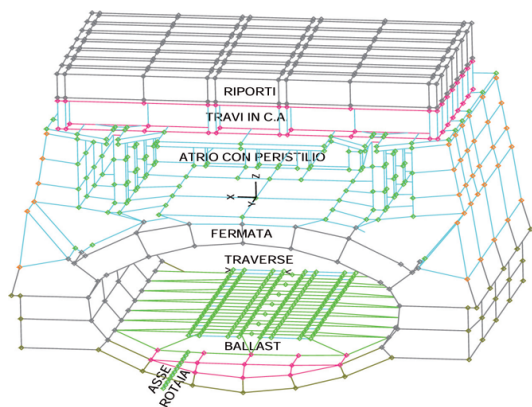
Mesh della fermata, con la stazione, corrispondente alla sezione 6. Station FE; tunnel between sections 4 and 9 of fig. 4.
